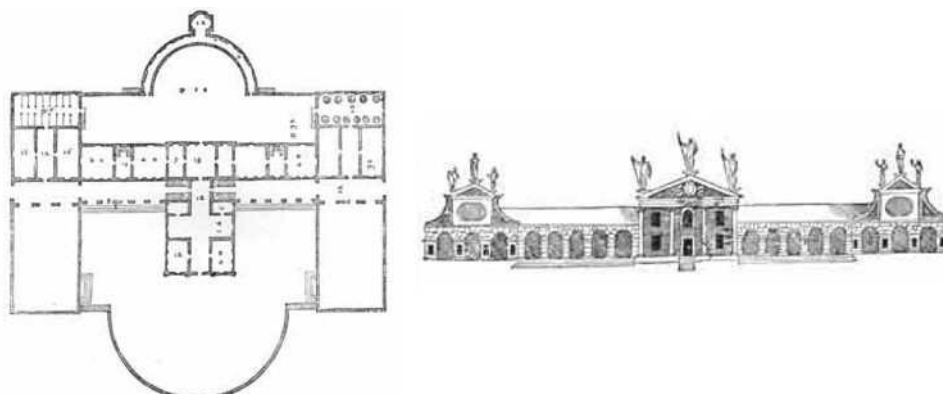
Villa Barbaro*, planta e alçado. (Palladio, 1570, p. 51)
